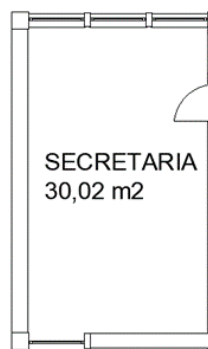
Planta em 2D da secretaria da AE ISEC.
